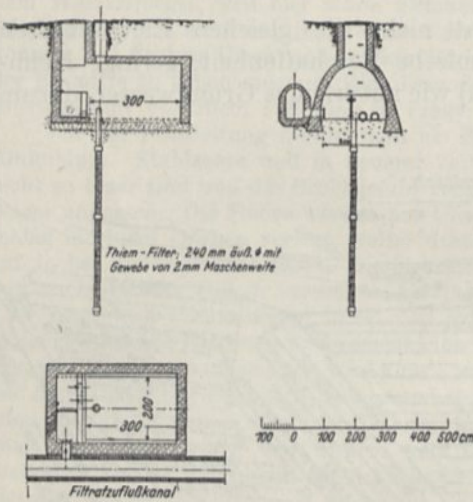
Künstliche Grundwassererzeugung mit Rohrbrunnen, nach »Das Gas- und Wasserfach«, Jahrgang 1931.
